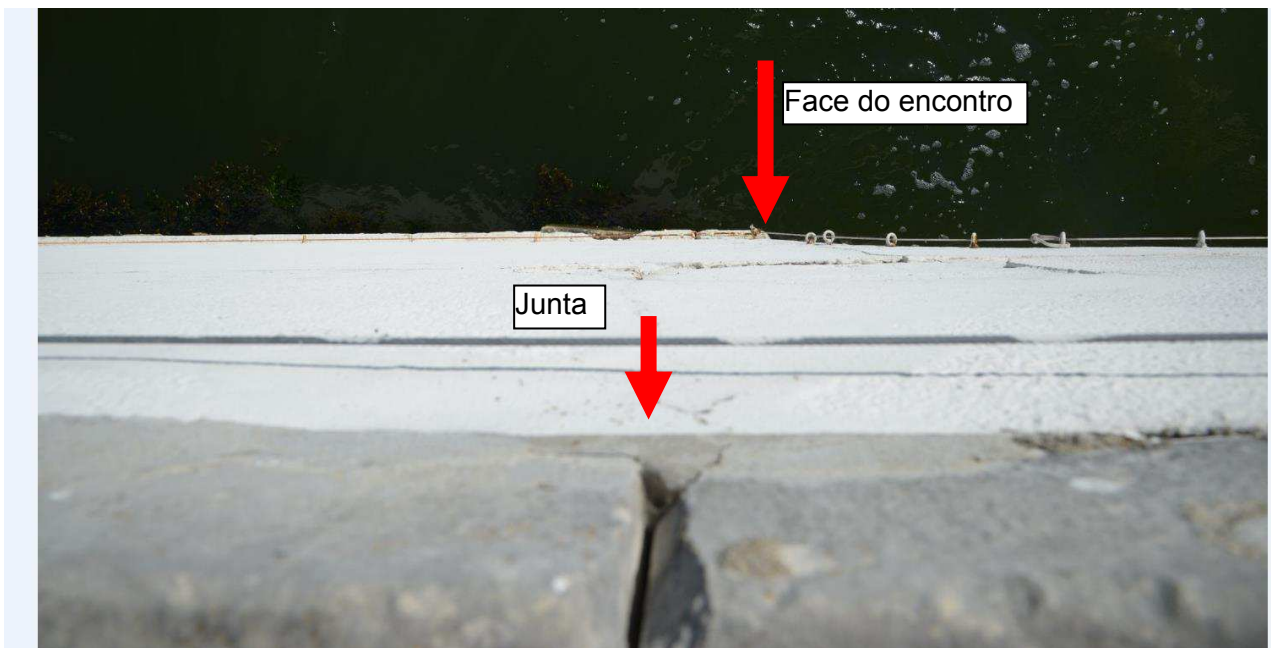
Ponte de S. João – Vista superior da junta do encontro Sul
